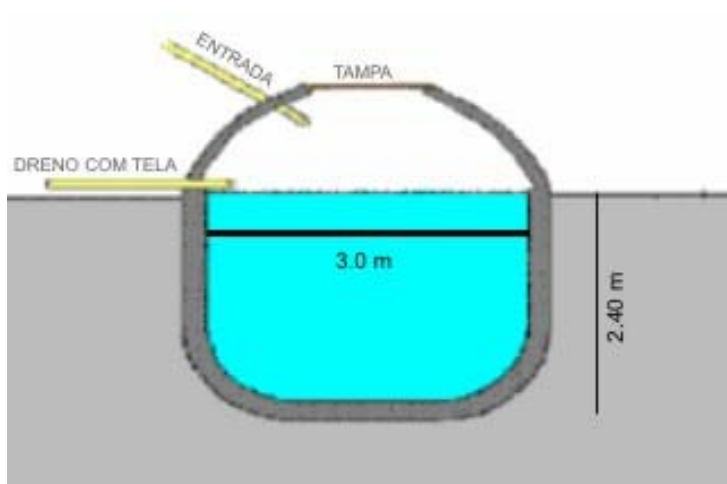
Cisterna subterrânea de massa cal e tijolos ³
